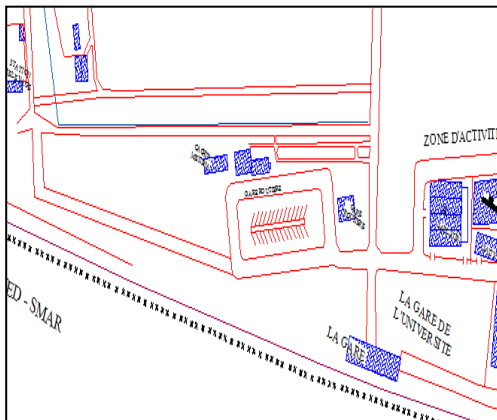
Vue en plan de la gare avant l'intervention (gare ferroviaire)
